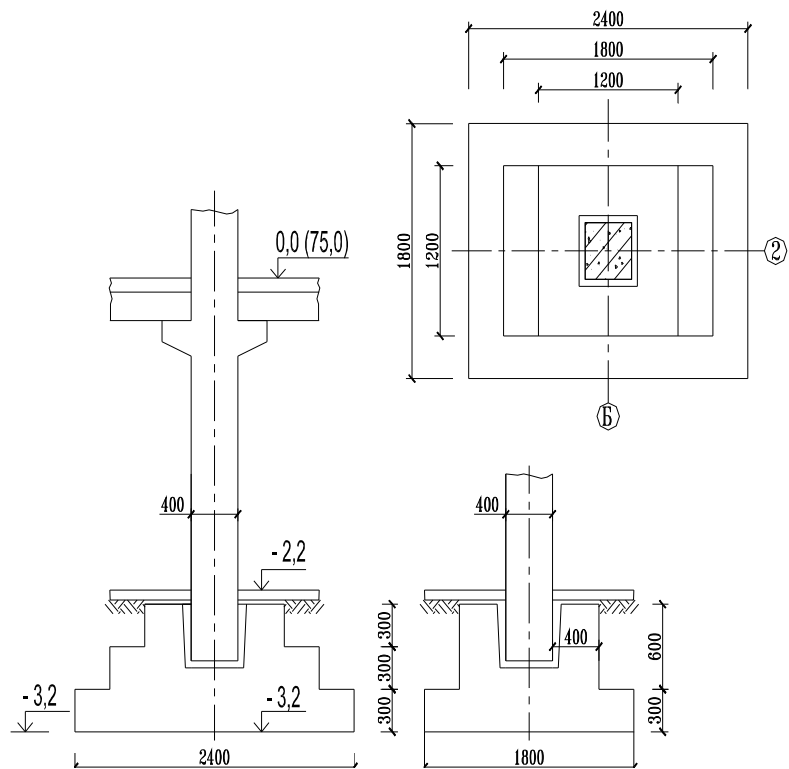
Пример конструкции монолитного фундамента в осях 2 Б.
